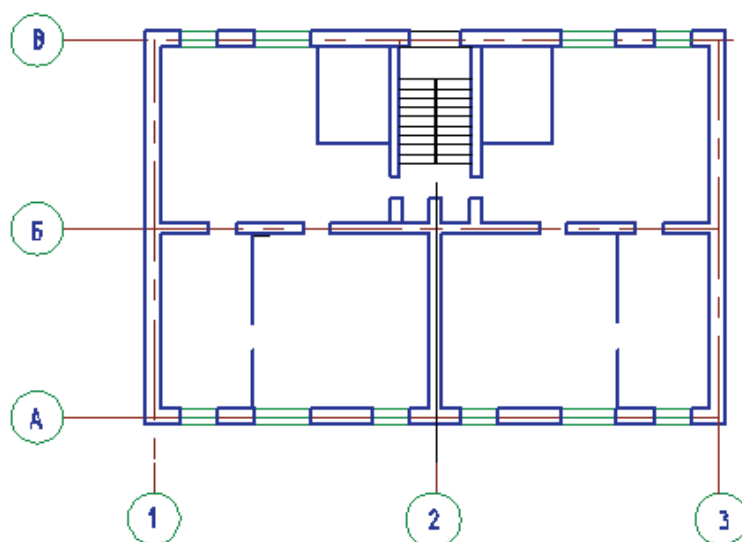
Формирование изображения простенков, лестничного марша на плане этажа
